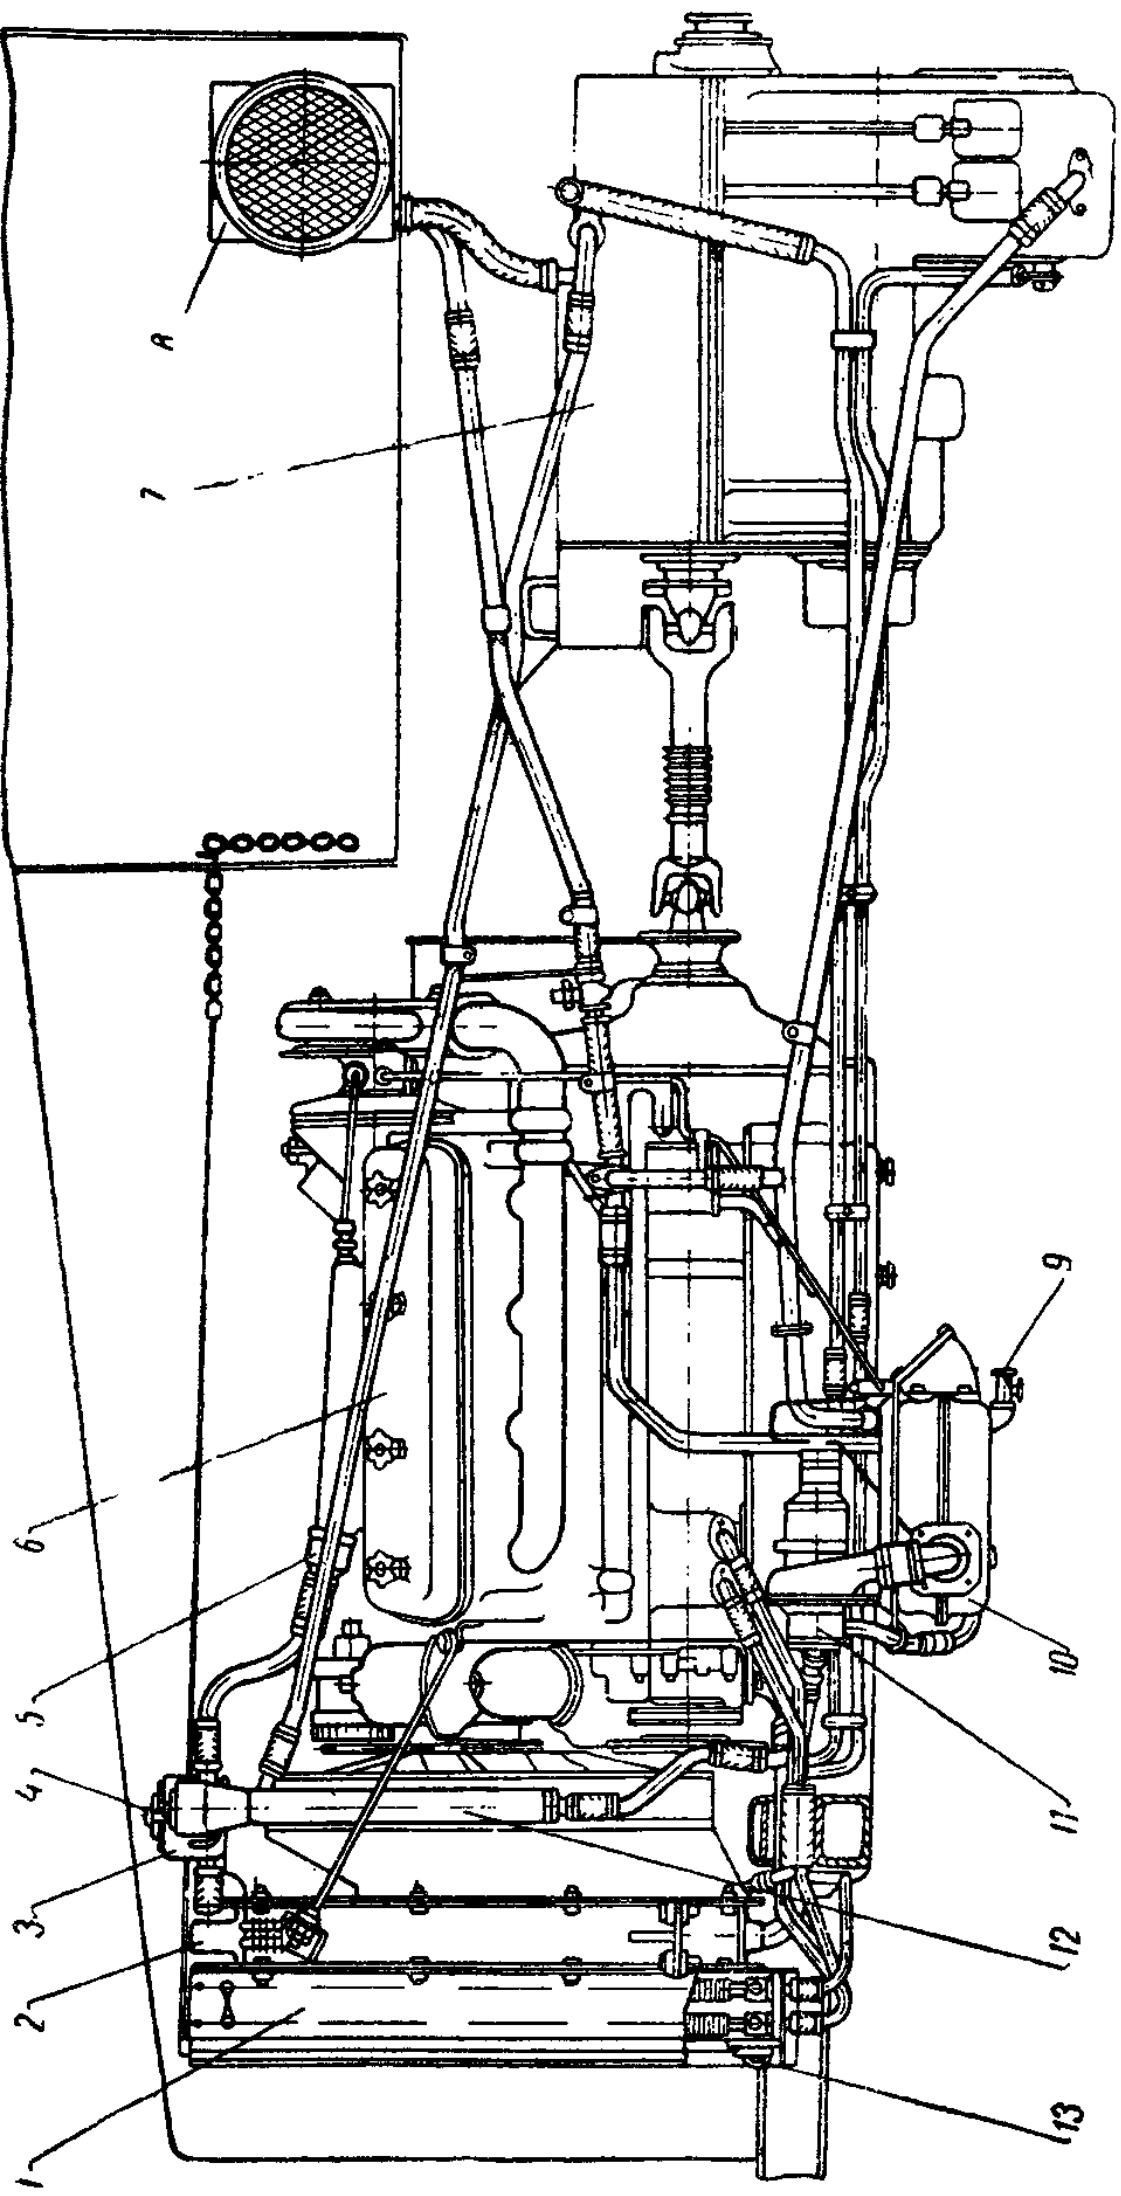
Система охлаждения предпускового обогрева и отопления:
